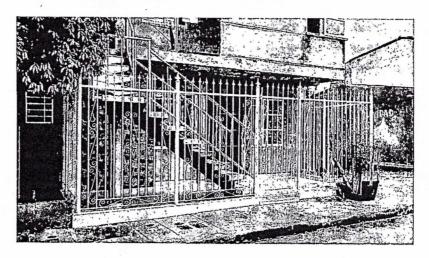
ESCALERA EN EL ÁREA DE ANTEJARDIN, DE LA VIVIENDA UBICADA EN LA MANZANA E, LOTE 13
